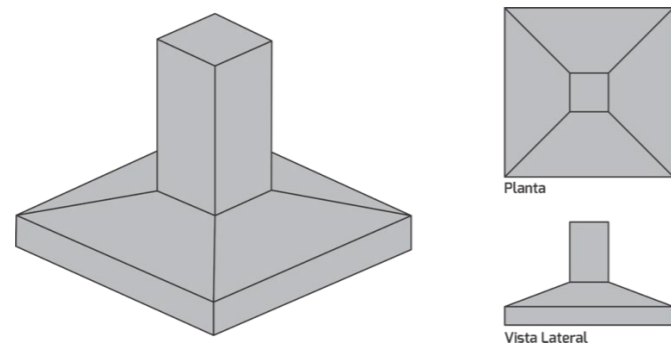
Esquema de zapata aislada. Fuente: Construcción en seco, Blog.
